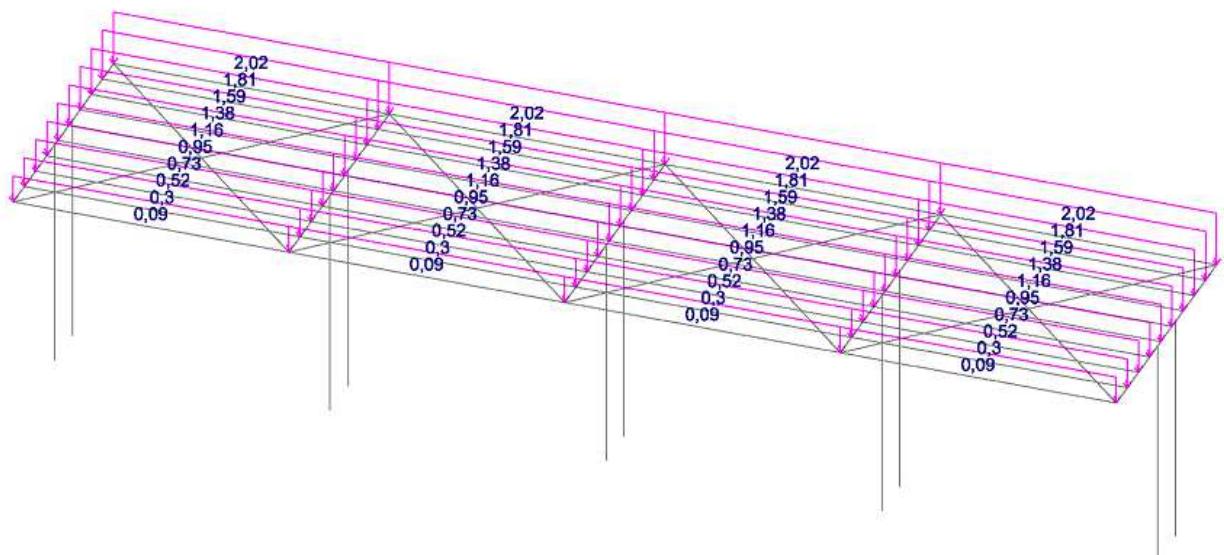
Схема загружения конструкции снеговой нагрузкой
